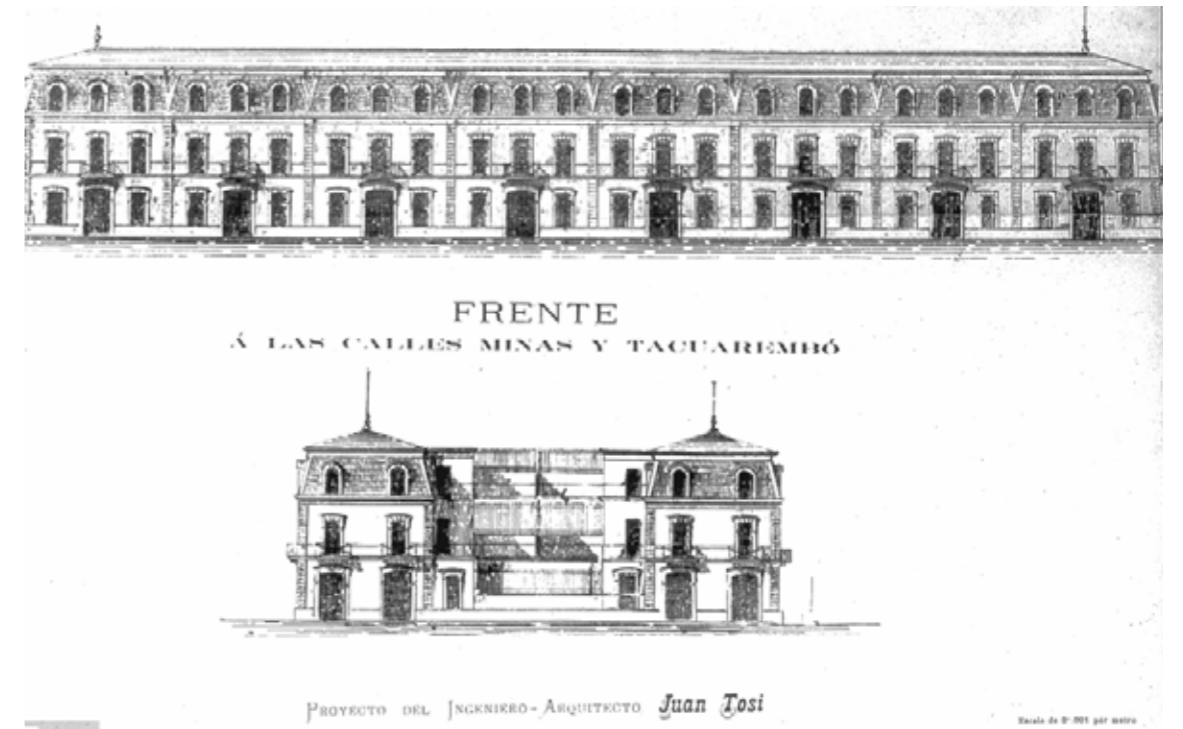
Fachadas. Fuente: IHA, Montevideo.
